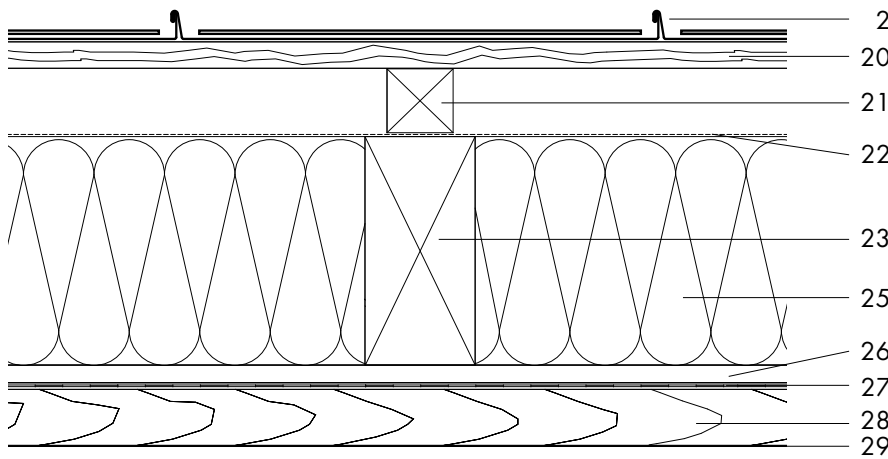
Belüfteter Dachaufbau mit RHEINZINK-Doppelstehfalzsystem
